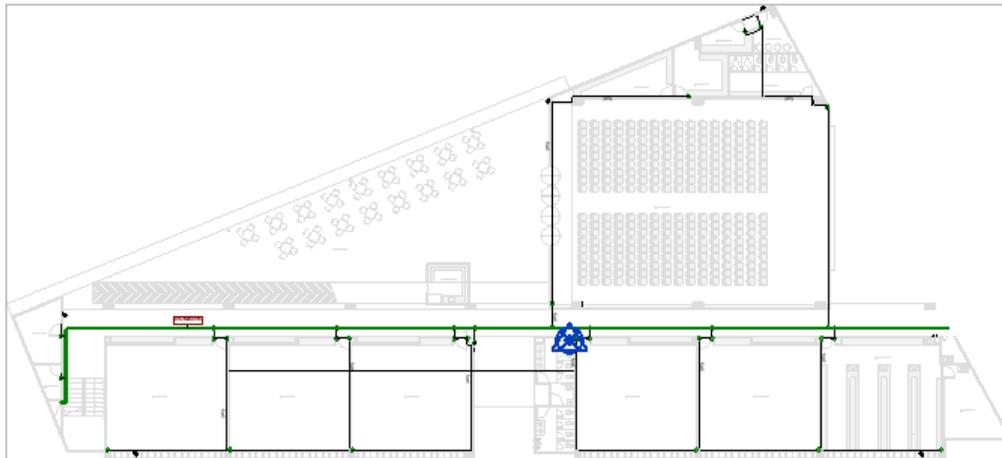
Vista en planta Piso 1 – CCTV – ALARMA DE INTRUSIÓN
